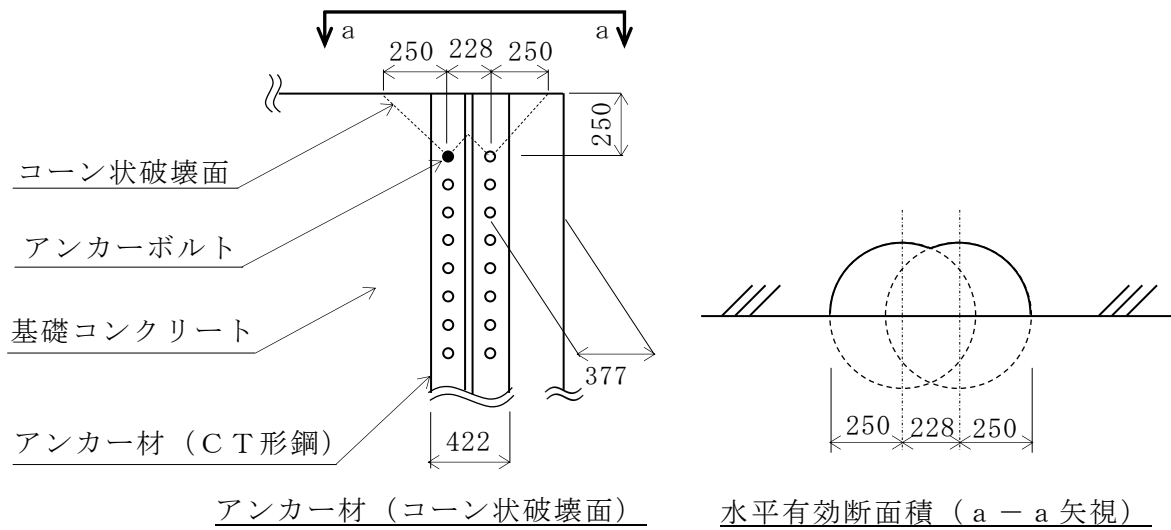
アンカーボルトのコーン状破壊の概要図 (単位 : mm)
